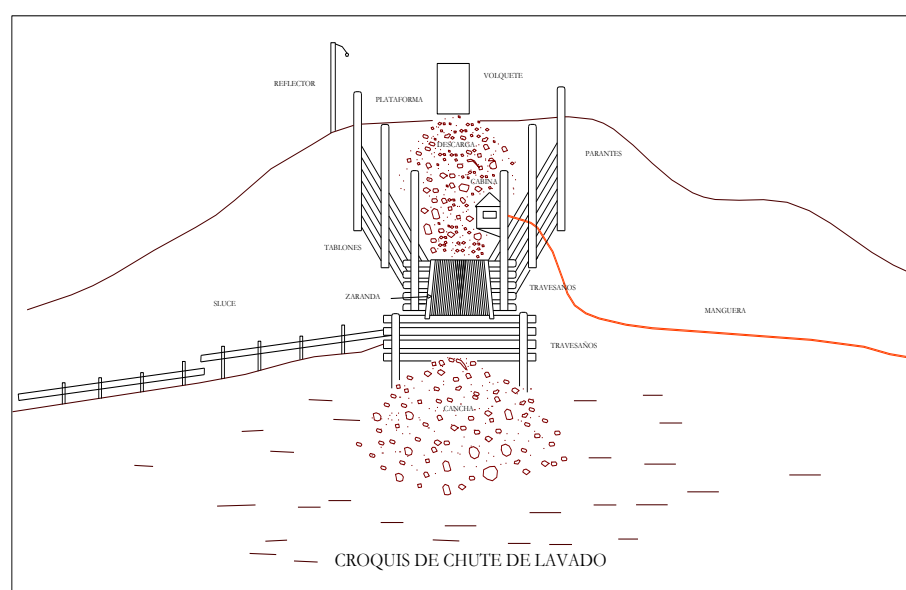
Croquis del chute de lavado y la parrilla fija
